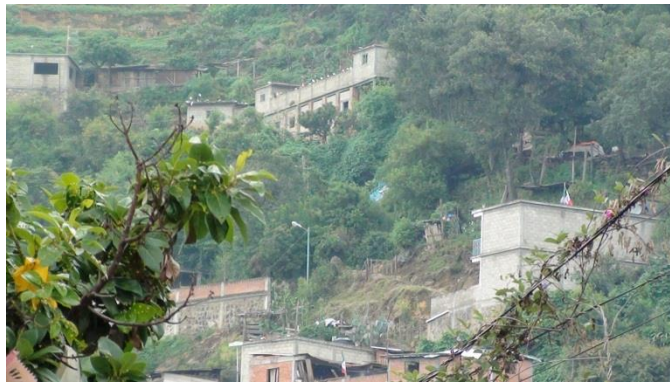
Vista de los cimientos que tienen las viviendas que están ubicadas en laderas de fuerte pendiente
